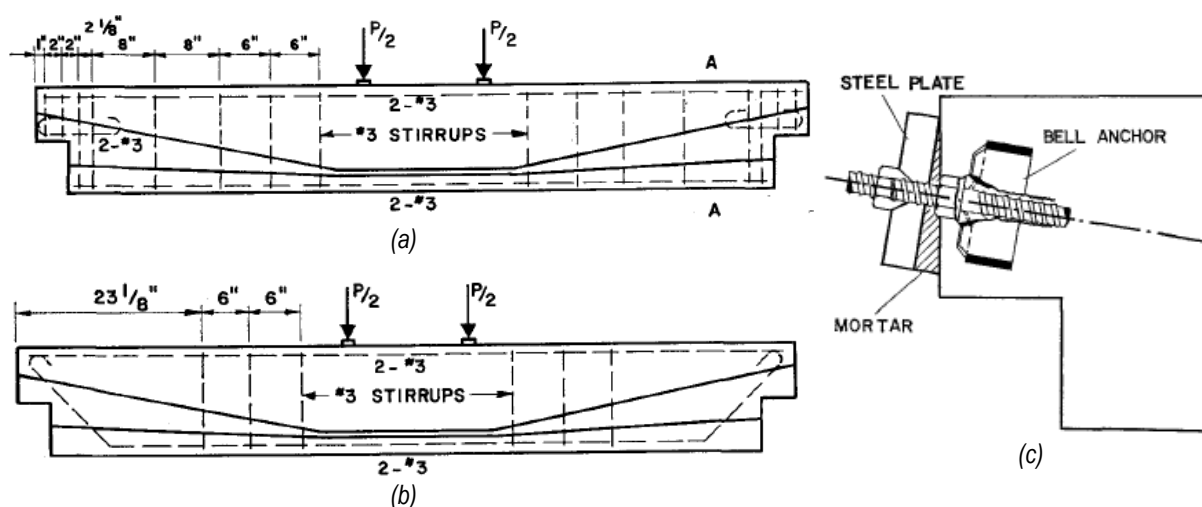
AMM ensayados por Werner y Dilger [35]: (a) Armado de piezas con armadura pasiva ortogonal; (b) Armado de piezas con armadura pasiva inclinada; (c) Detalle del anclaje de la armadura activa
